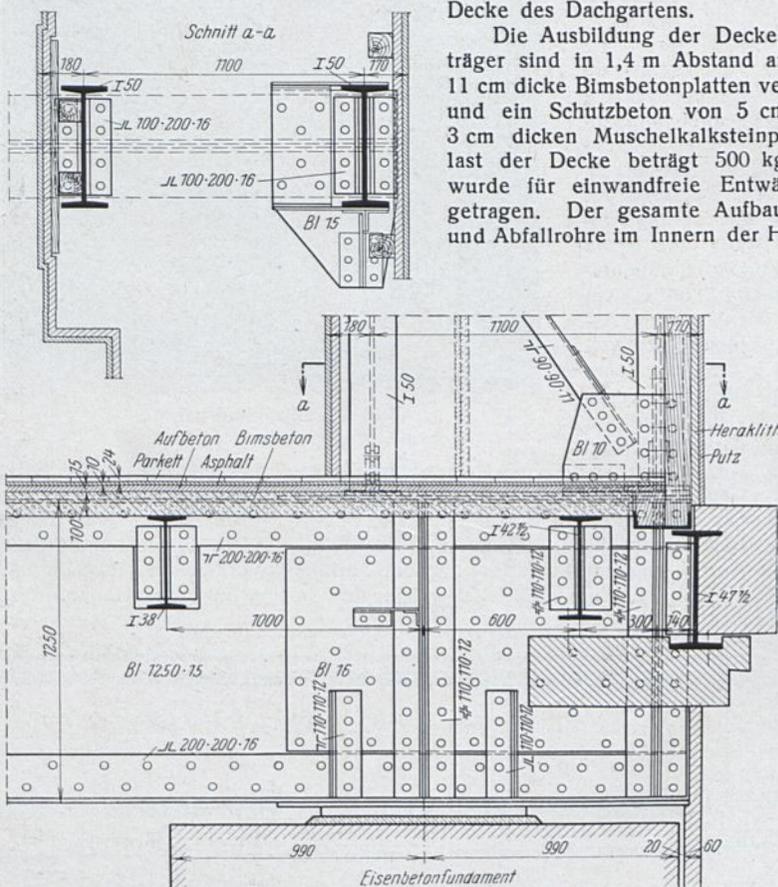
Ausbildung der Hallendecke über der Avenue de Tokio.
